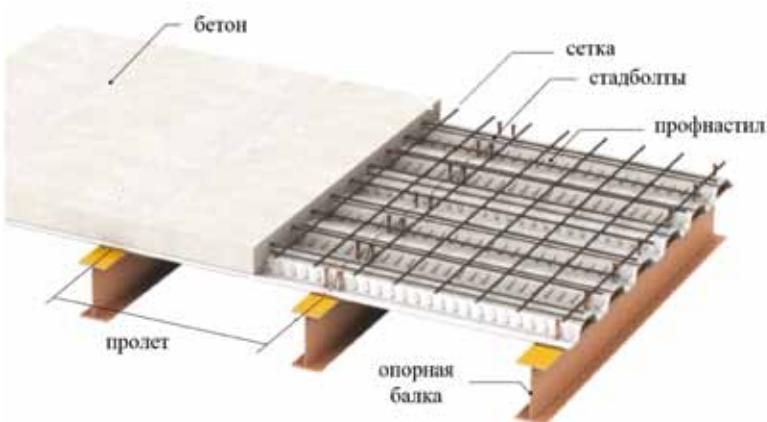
Принципиальный вид конструкции сталебетонного перекрытия
